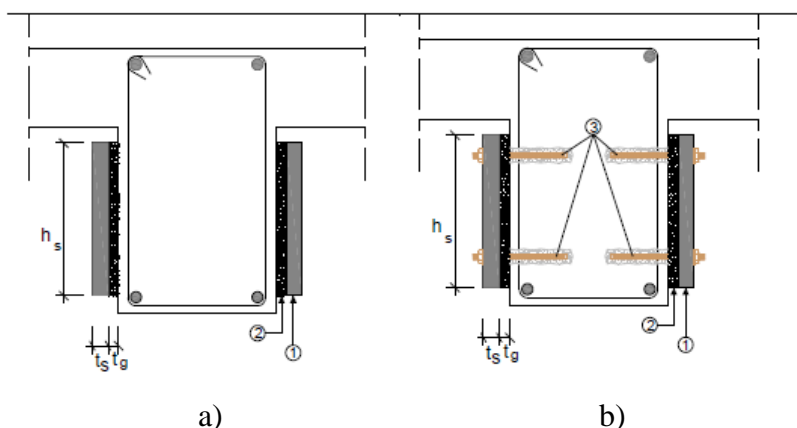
Reforço de vigas ao esforço transversal (dimensões recomendadas): a) sem buchas metálicas; b) com buchas metálicas; adaptado de Sousa (2008)
